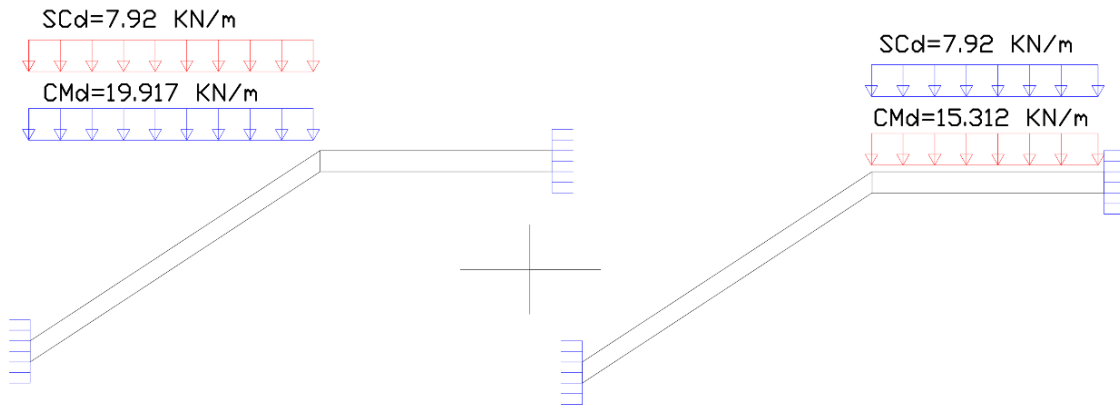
Consideración de la escalera para el cálculo de la armadura negativa.
